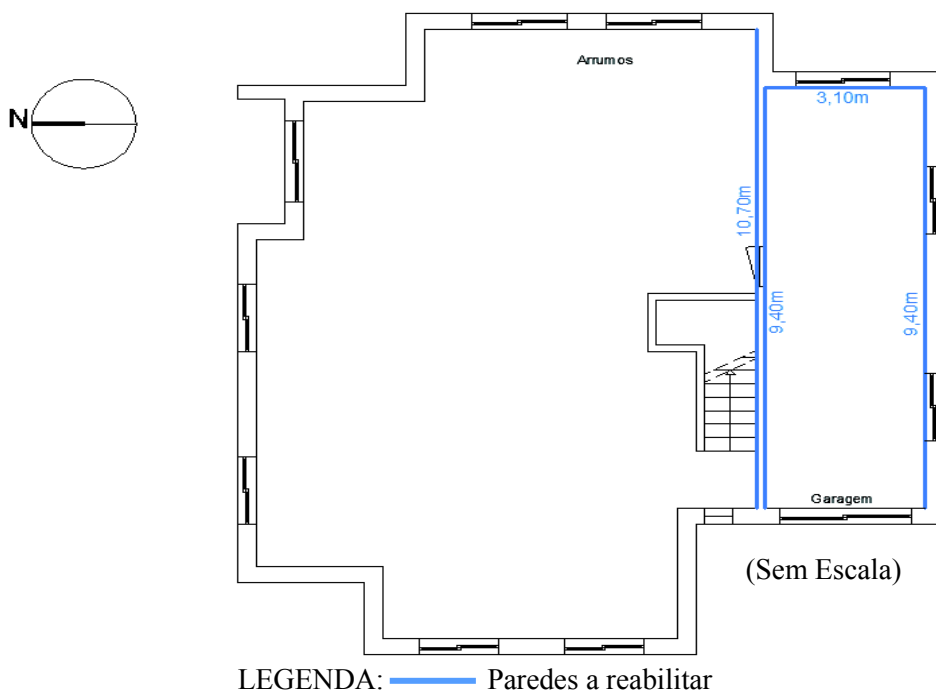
Planta da cave – Identificação da zona a reabilitar
